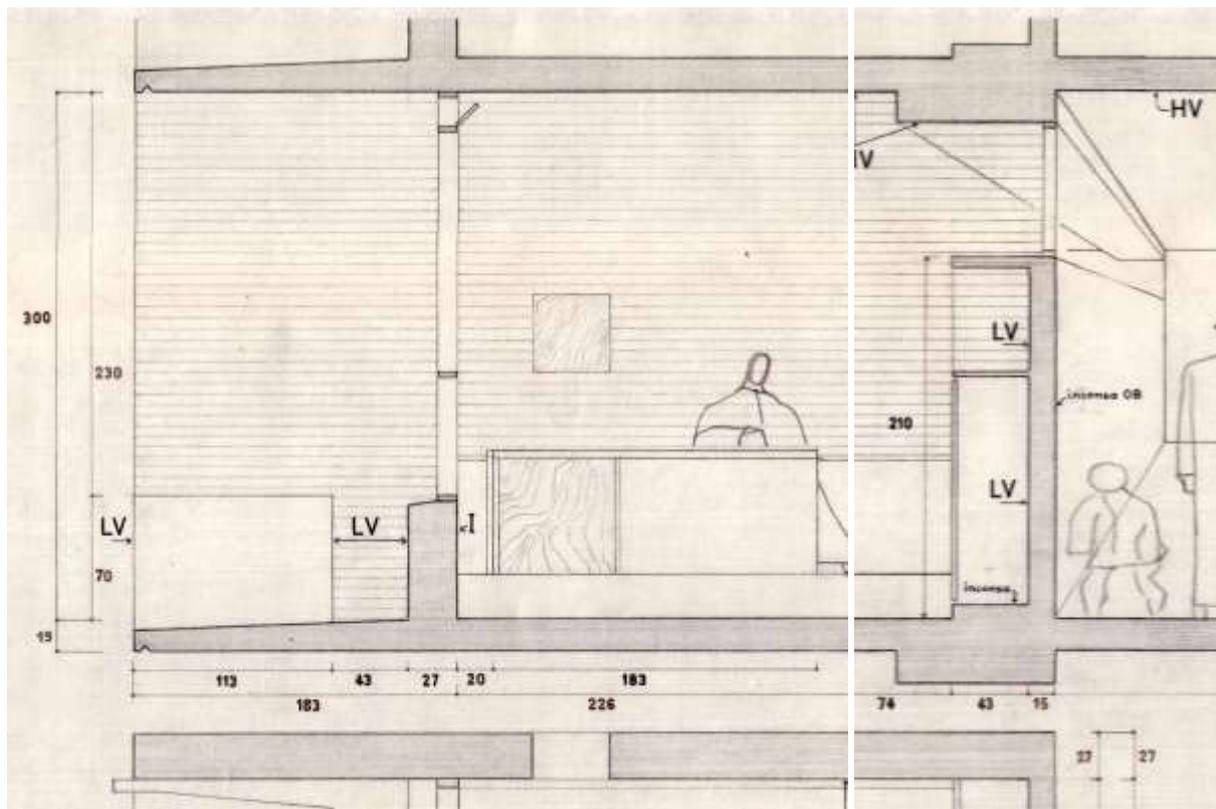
/ Sector del Plano PG09, Ca.1961 / DDI-IH N°16.953
